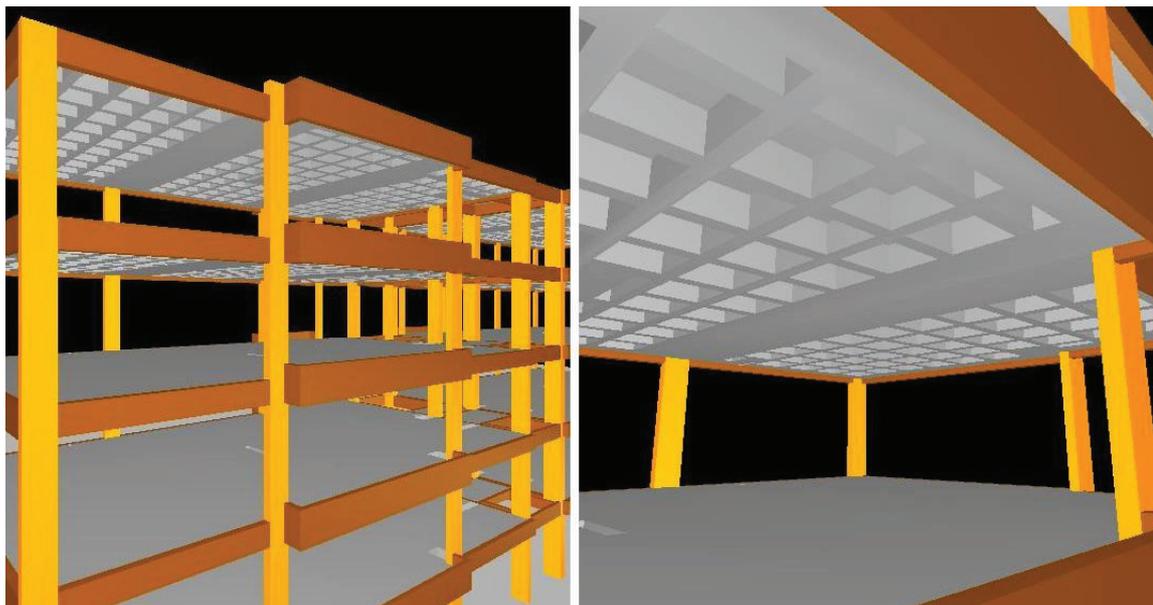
perspectiva dos pavimentos tipo da estrutura em laje nervurada com cubetas de polipropileno
